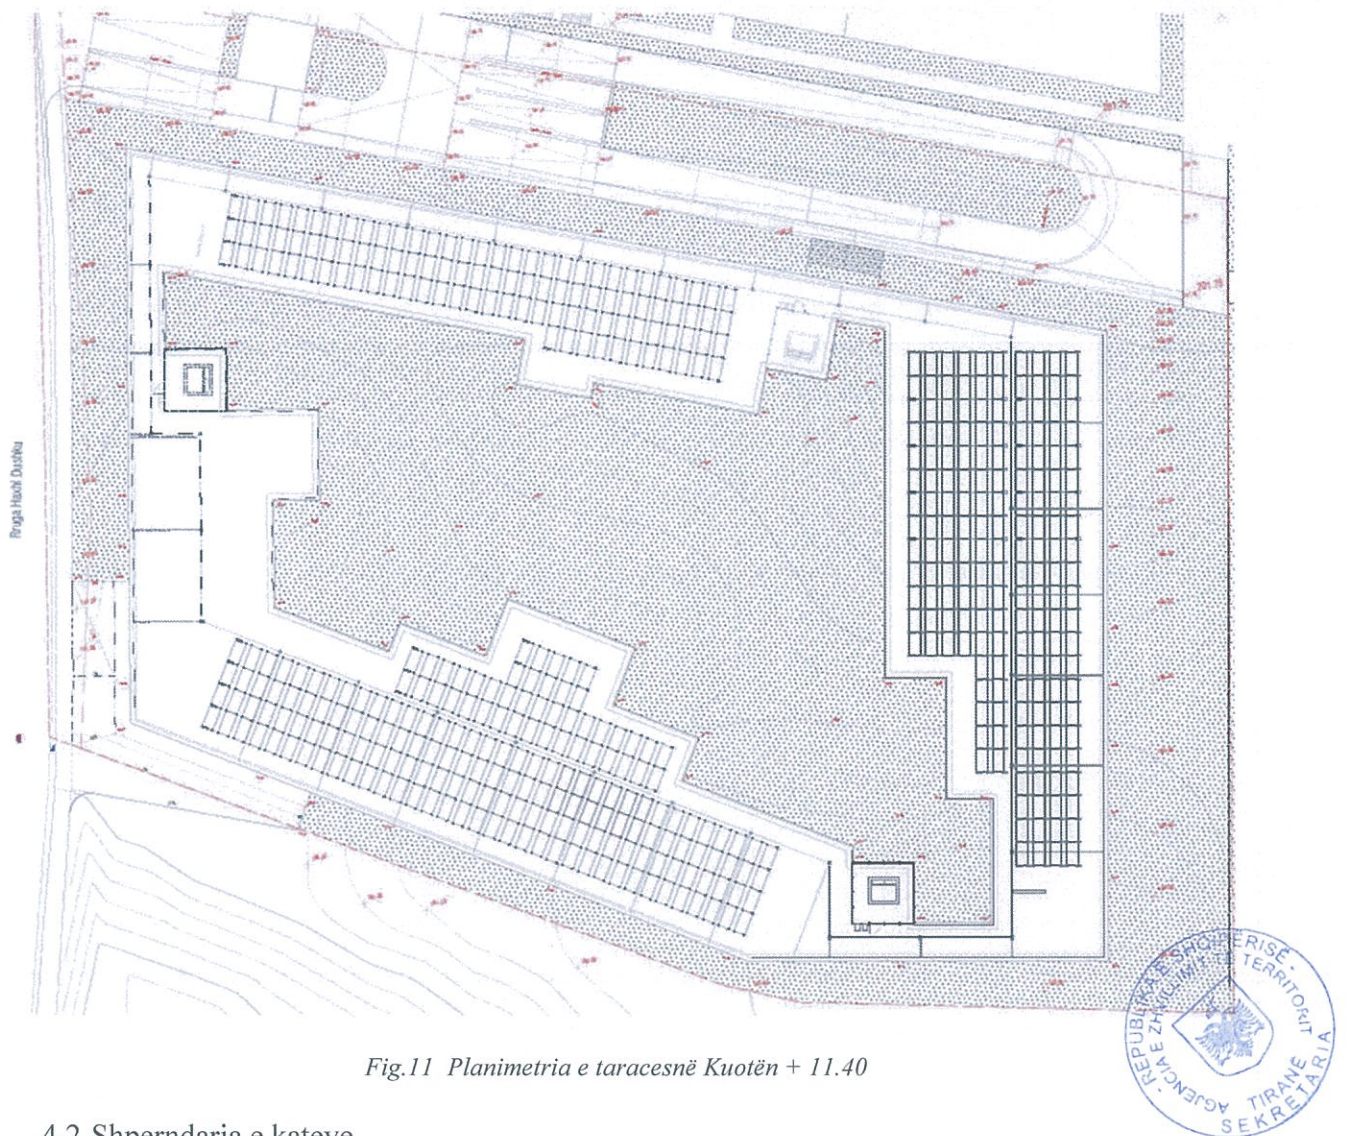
Planimetria e taracesnë Kuotën + 11.40
